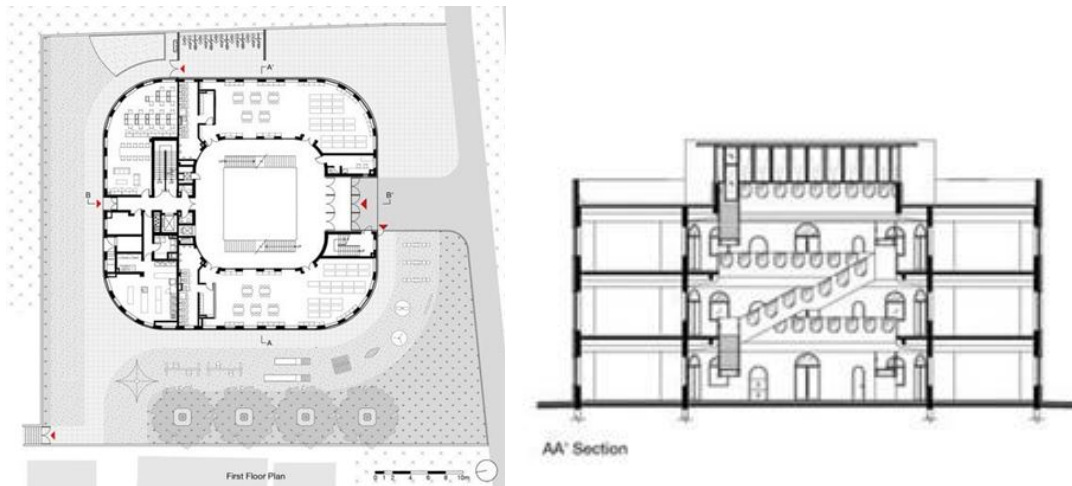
План першого поверху та розріз Kaleidoscope Kindergarten
